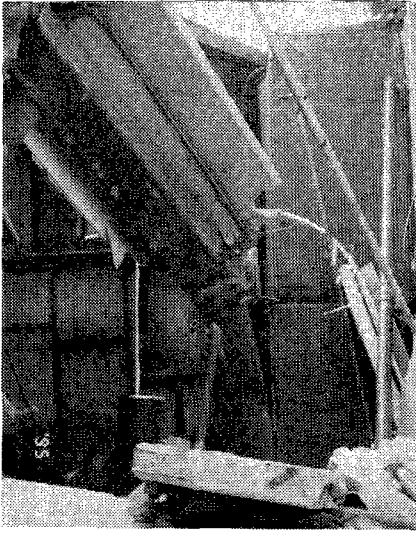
鉄骨柱脚部アンカー筋の破断による倒壊
